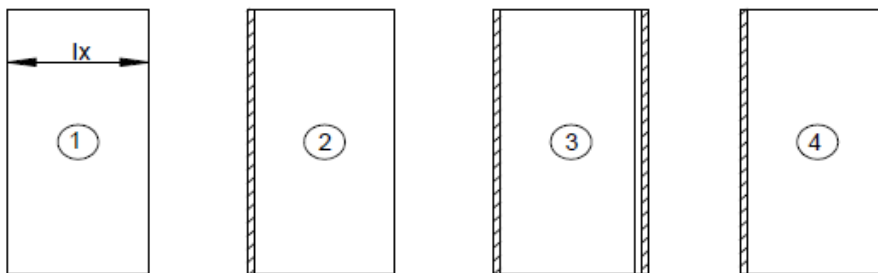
Vinculações das lajes que trabalham em uma direção
